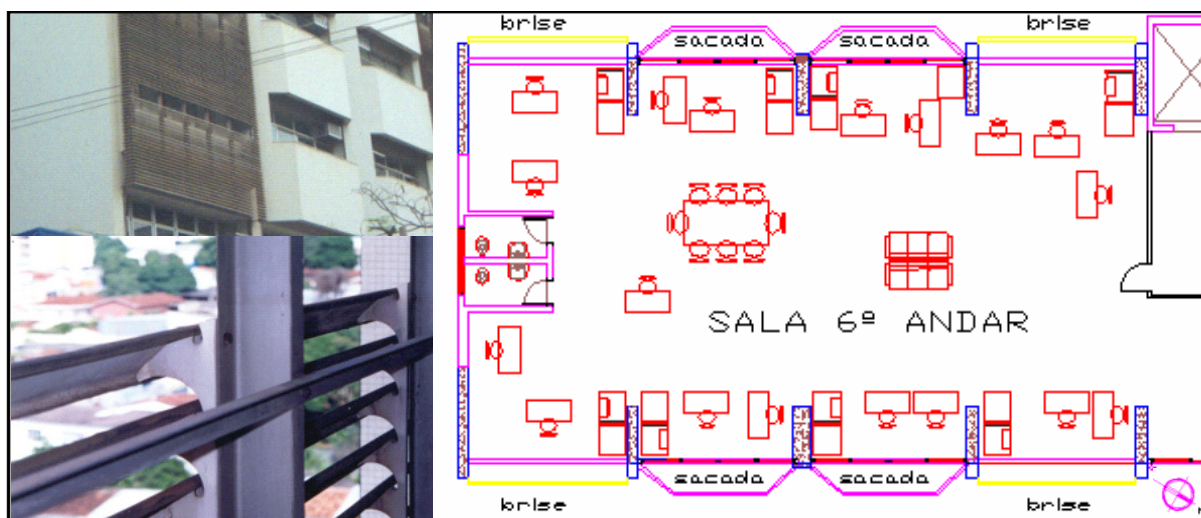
fotografia externa, interna e planta tipo do edifício do INSS
